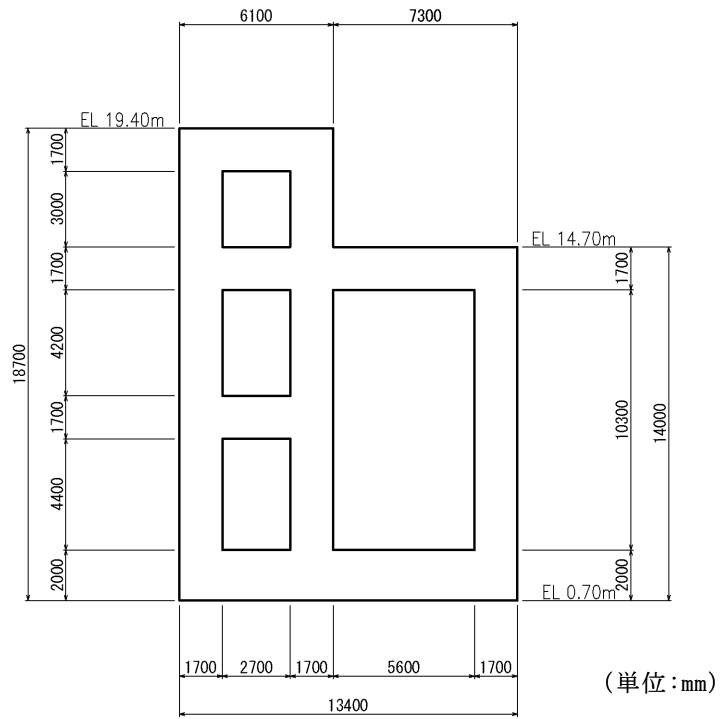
第 1 ベントフィルタ格納槽 断面図 (A-A 断面)
